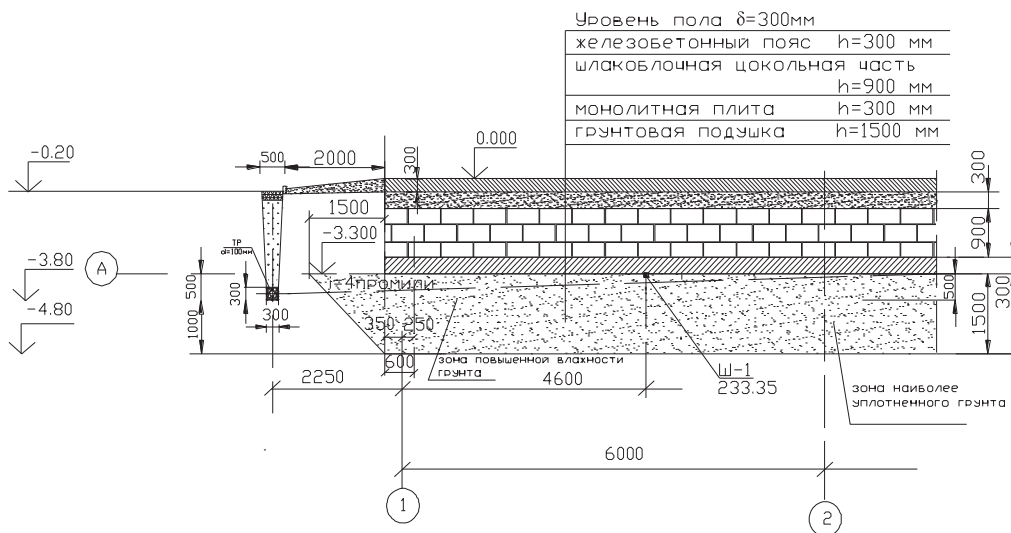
Фрагмент плитного фундамента и грунтовой подушки
